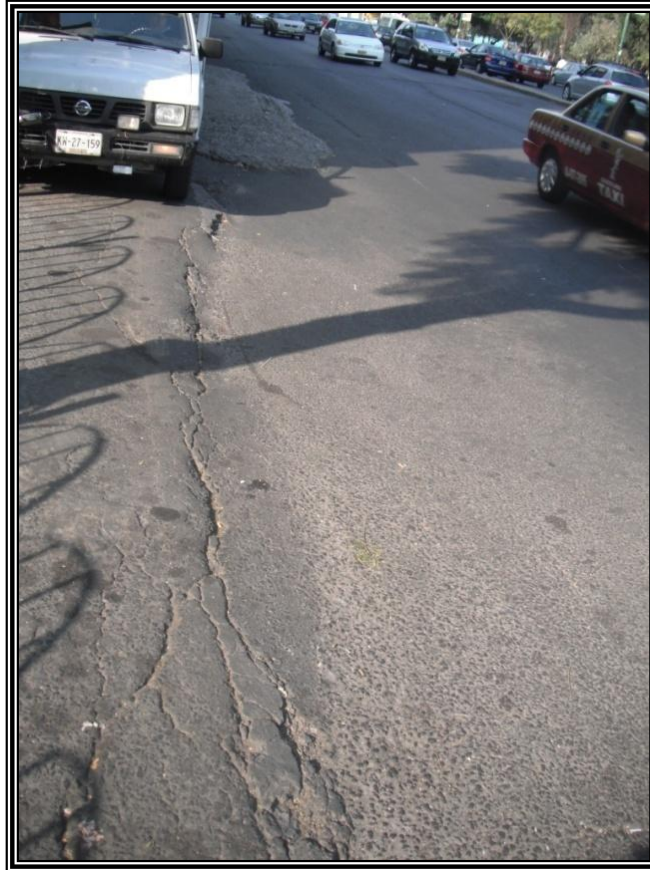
Fracturas en el pavimento en la Avenida Canal de Miramontes, en la colonia Los Girasoles.
